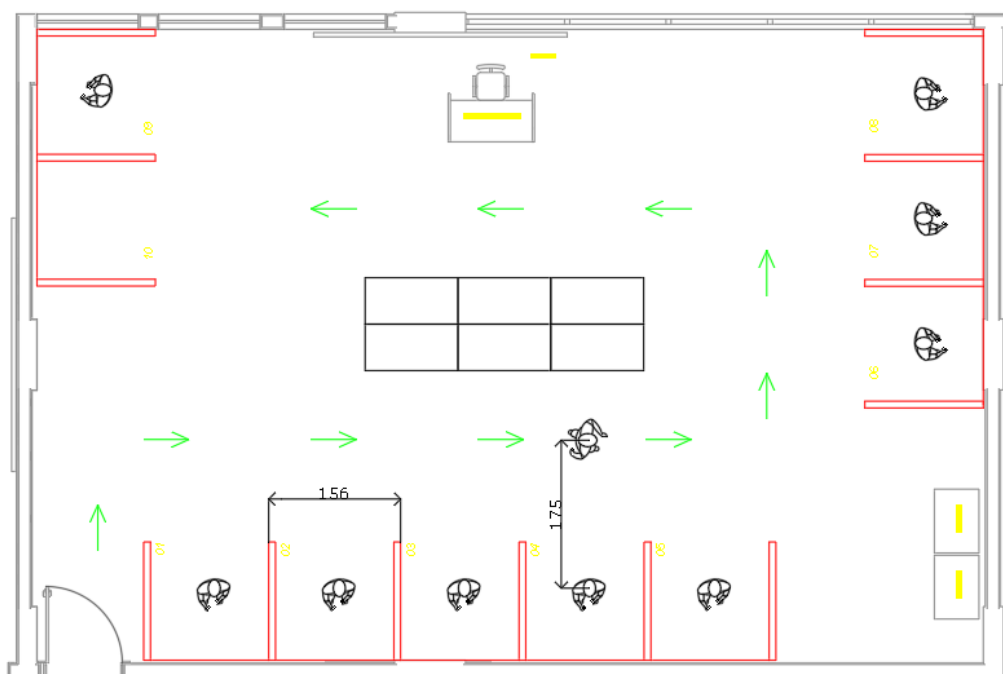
Layout laboratório de instalações elétricas. Fonte: Autor.
